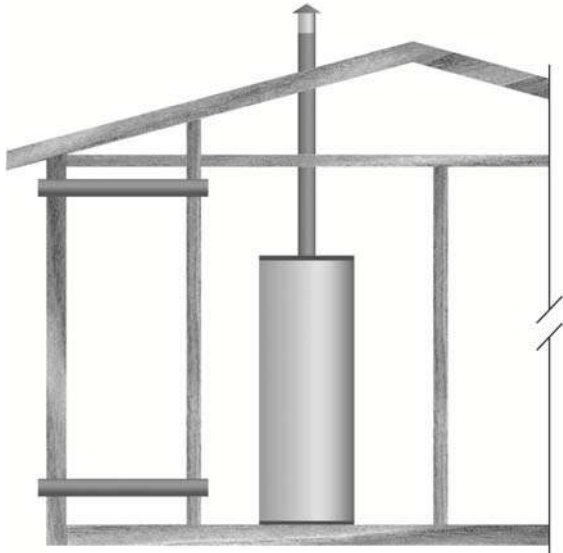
AIR FRAIS PAR DEUX CONDUITS HORIZONTALS
